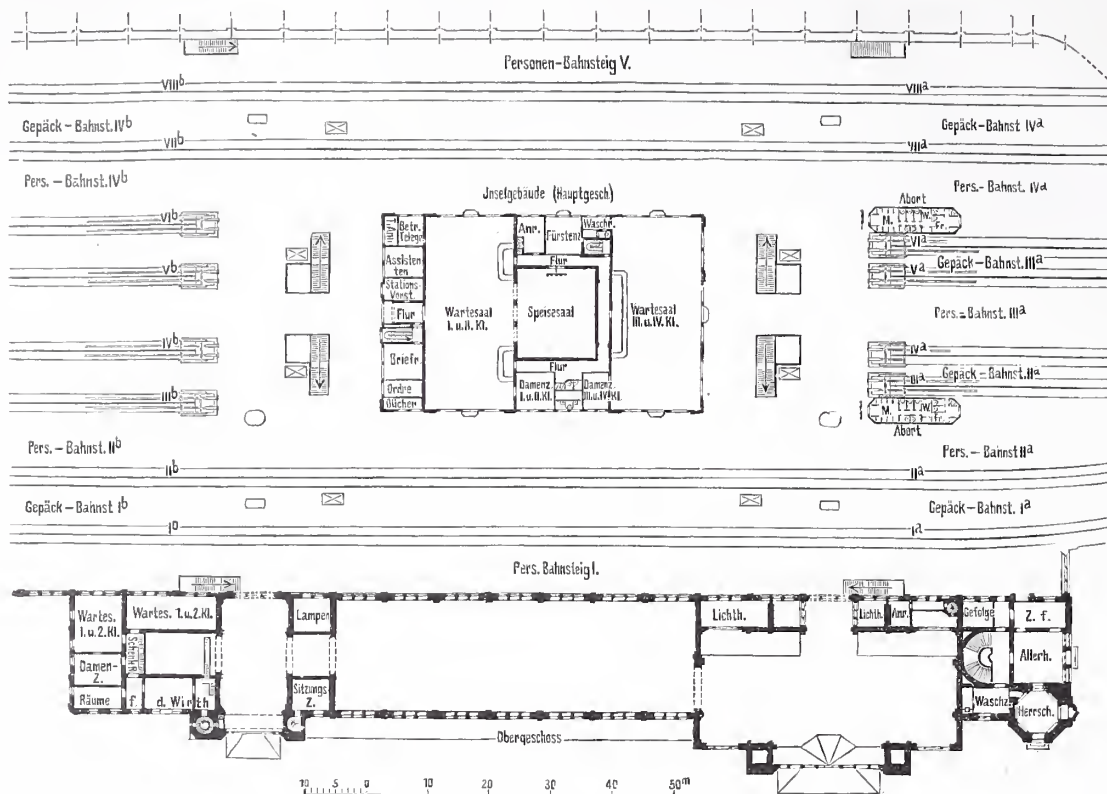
Grundriss in Höhe des Bahnsteigs.
